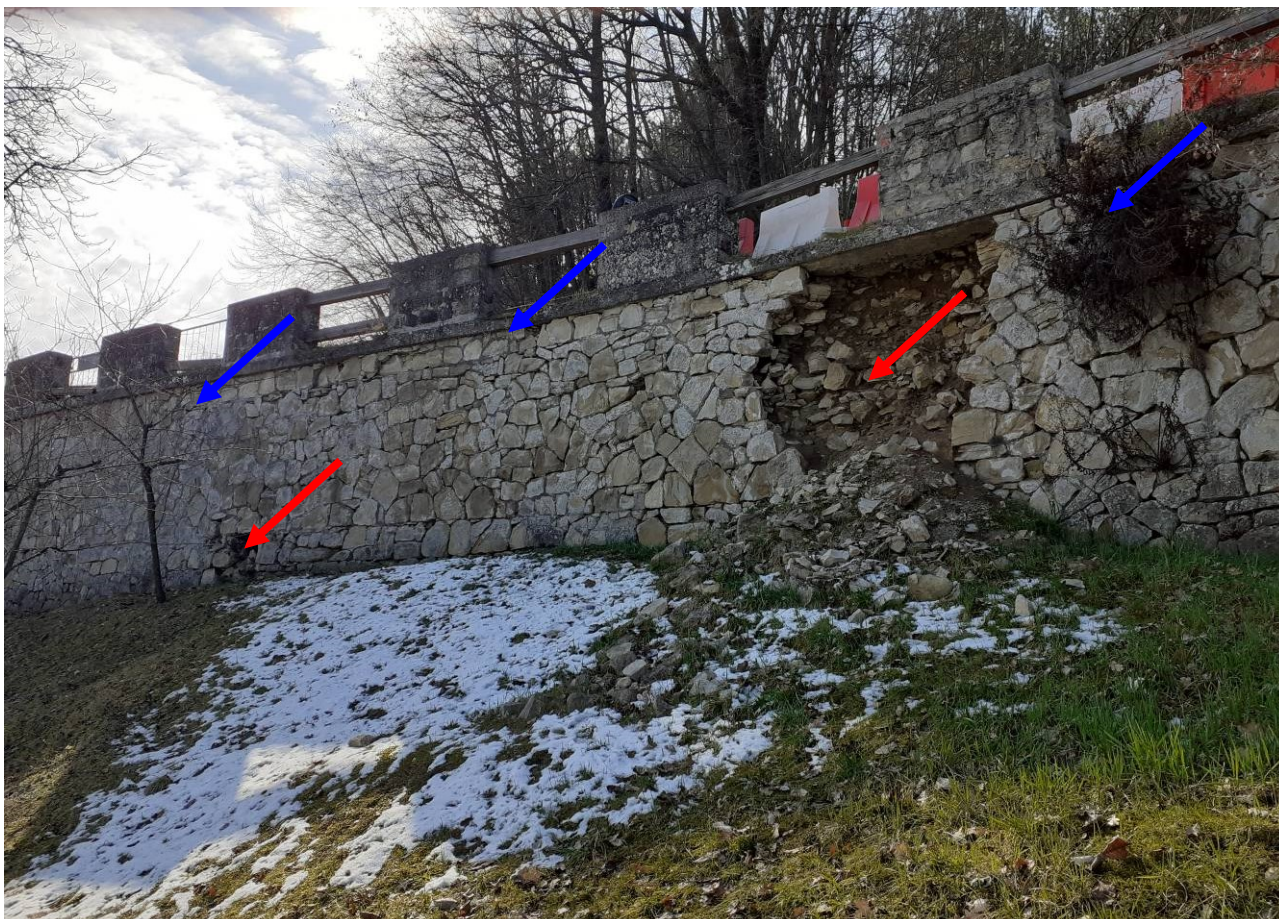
Vista del tratto del muro sottoscarpa in sasso lesionato, che verrà ripristinato mediante ripresa in breccia e cuci-scuci (indicati dalle frecce rosse), nella parte alta verrà realizzata un’opera in cemento armato a “Z” sulla quale verrà installata una barriera di sicurezza stradale (indicati dalle frecce blu).
